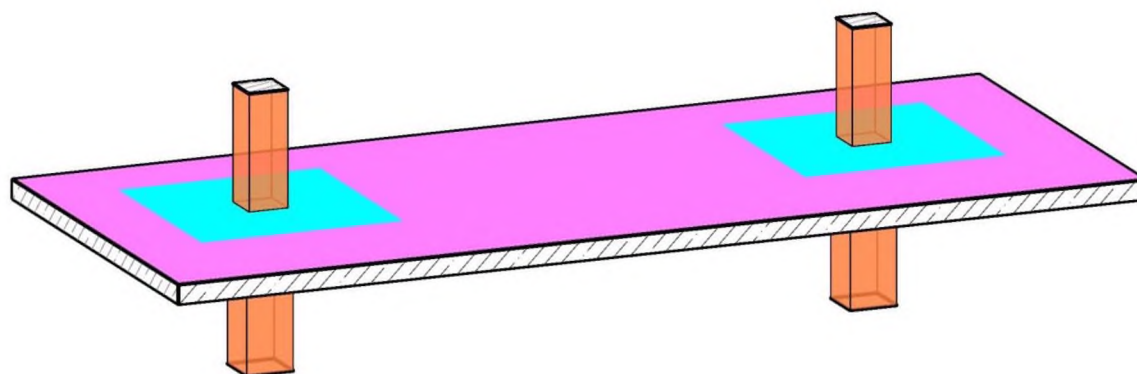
Общий 3D вид плиты перекрытия в виде конструктивных элементов
